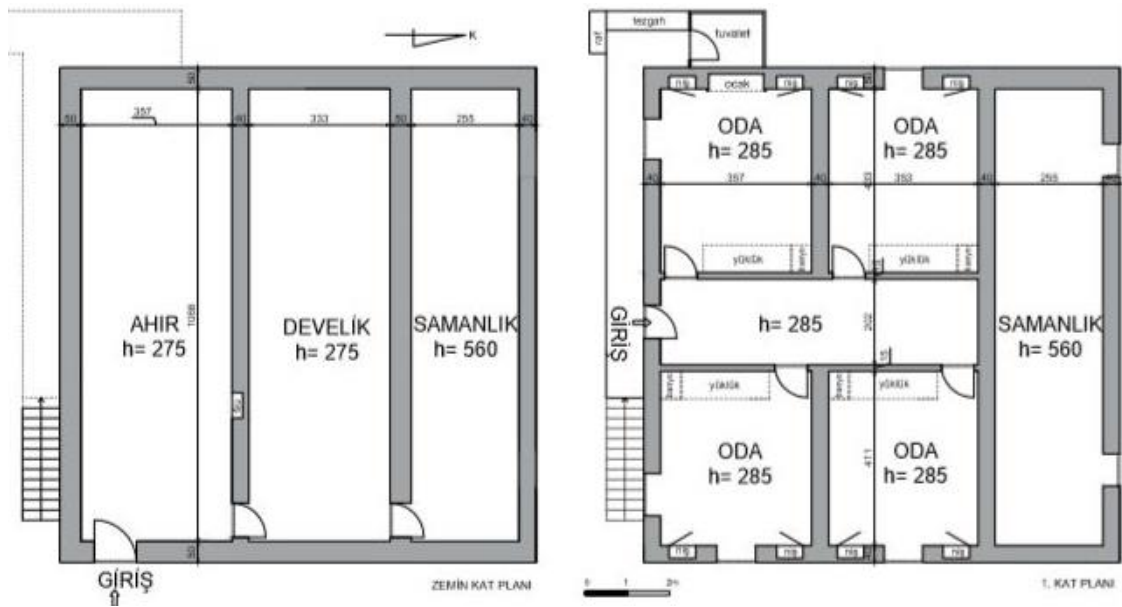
Gümüşyaka, yerleşim planı (Orijinal 2018)
